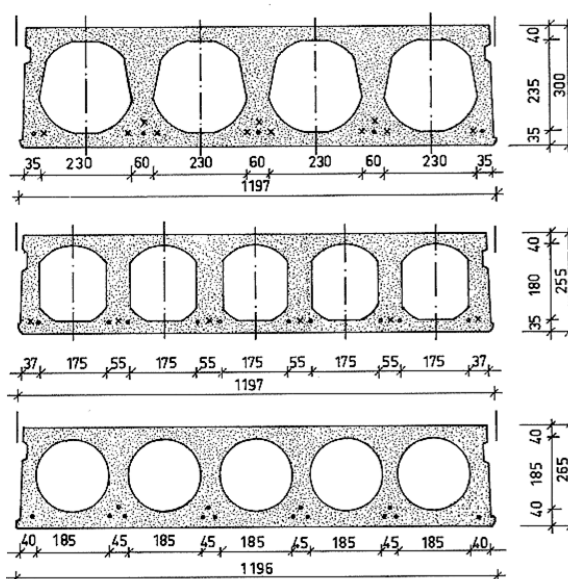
Lajes ensaiadas à flexão e ao cisalhamento respectivamente. (MERCX; WALRAVEN, 1983)
